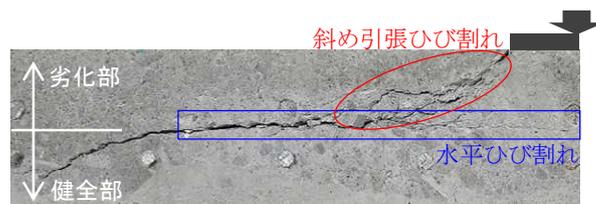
凍害劣化部に発生した斜め引張ひび割れ⁴⁾
